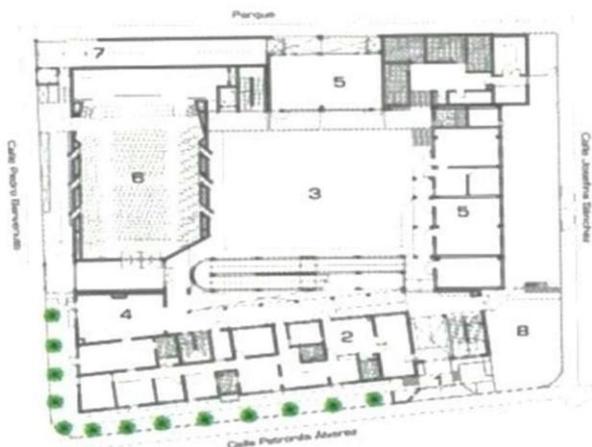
Planta. Centro Educ Ann Sullivan Fuente Google Figura 10. Vista de la fachada exterior. Fuente: Google
